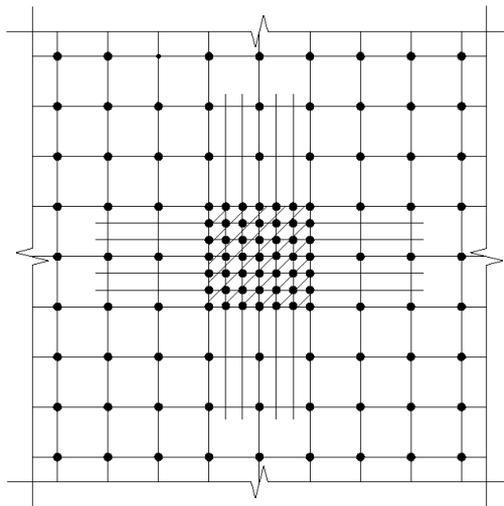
模板支撑架加密区立杆布置平面示意图
